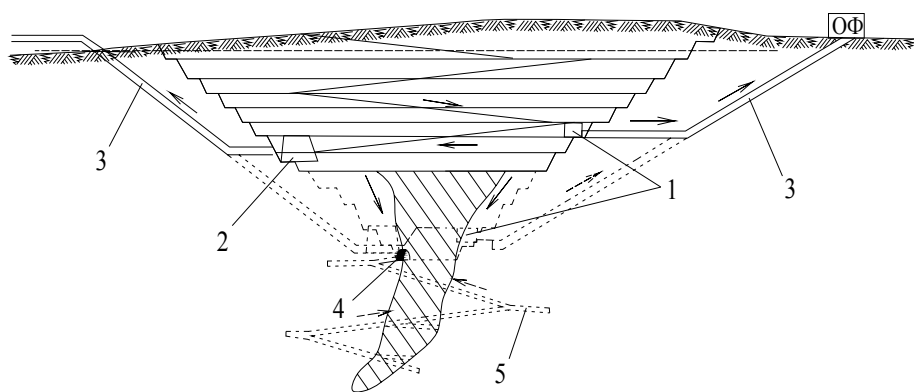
Технологическая схема расположения КНК в подземных наклонных выработках, пройденных из карьера: 1 – дробильно-перегрузочный пункт полезного ископаемого; 2 – дробильно-перегрузочный пункт вскрышных пород; 3 – конвейер, расположенный в подземной выработке; 4 – портал наклонного съезда, пройденного со дна карьера; 5 – наклонный съезд
